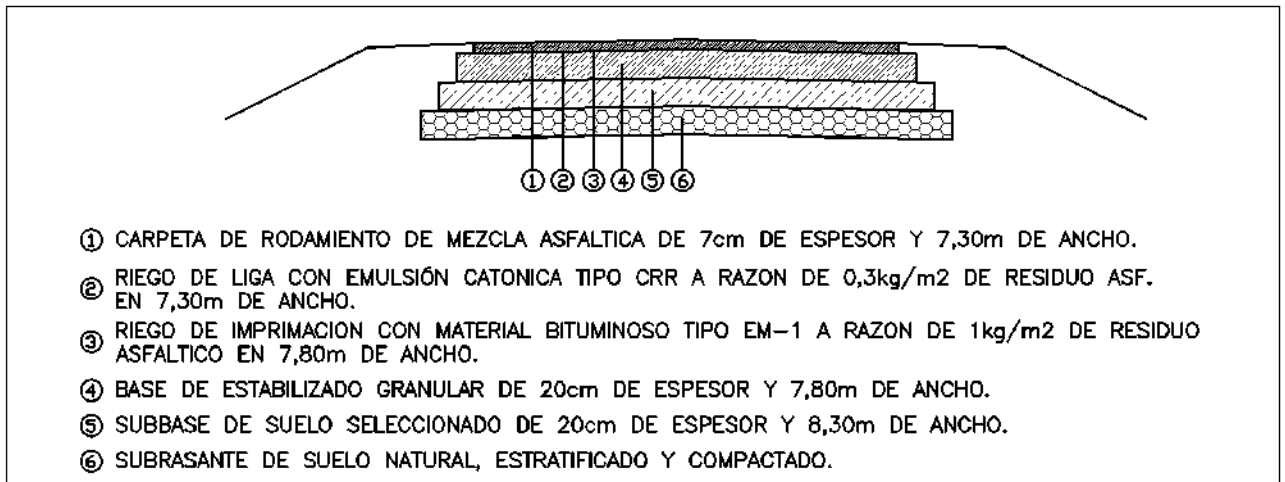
Paquete estructural de pavimento flexible para vías de circulación .
